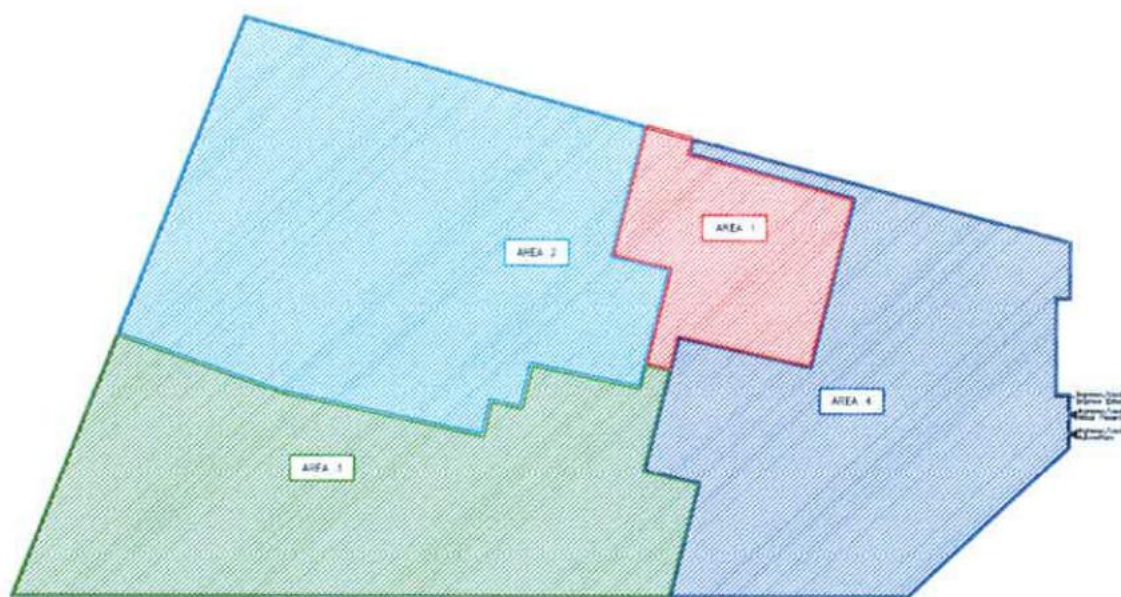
Planimetria dello Stabilimento e suddivisione in aree omogenee
